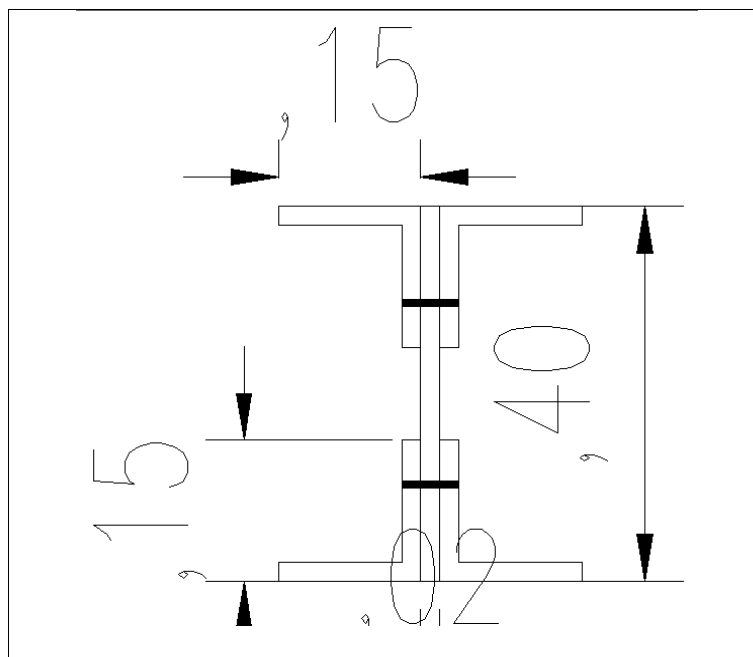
Sección del elemento tipo 3-23(Diagonal Larga), Puente 2. Fuente (Autores).
